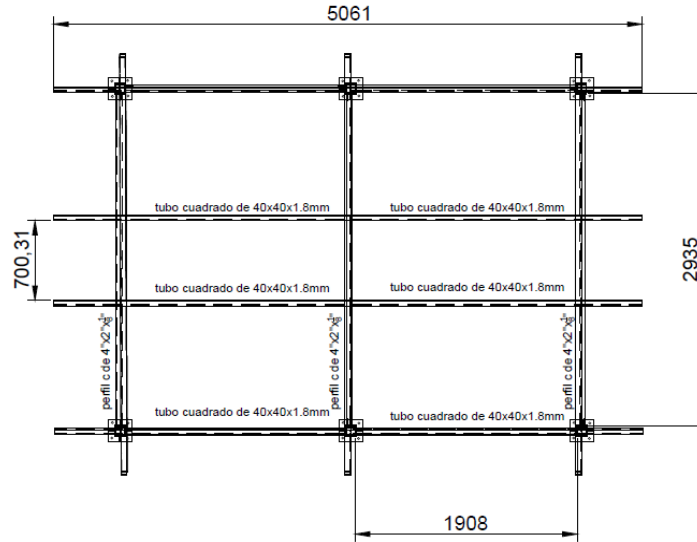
Vista en planta de la estructura de soporte (Elaboración propia).
